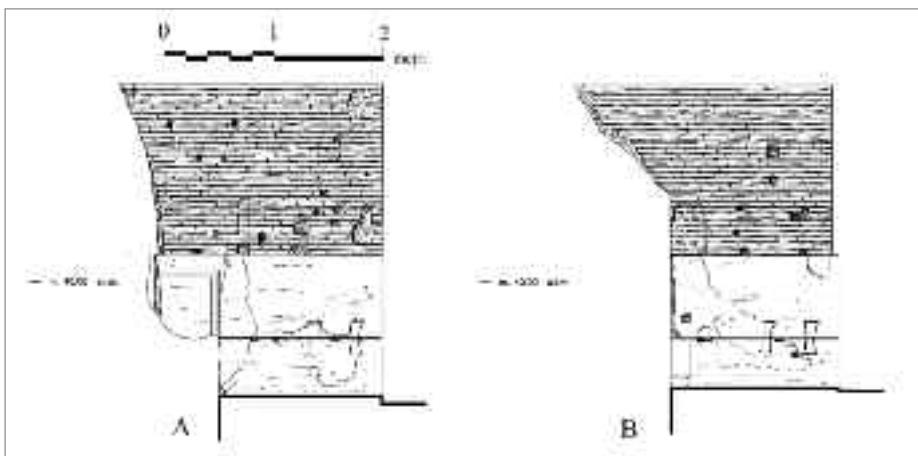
Corridoio ovest. Prospetto del lato nord del primo pilastro da sud (A). Prospetto del lato nord del terzo pilastro da sud (B). (Archivio grafico del Museo dei Fori Imperiali - M. Bianchini - V. Alunni)
